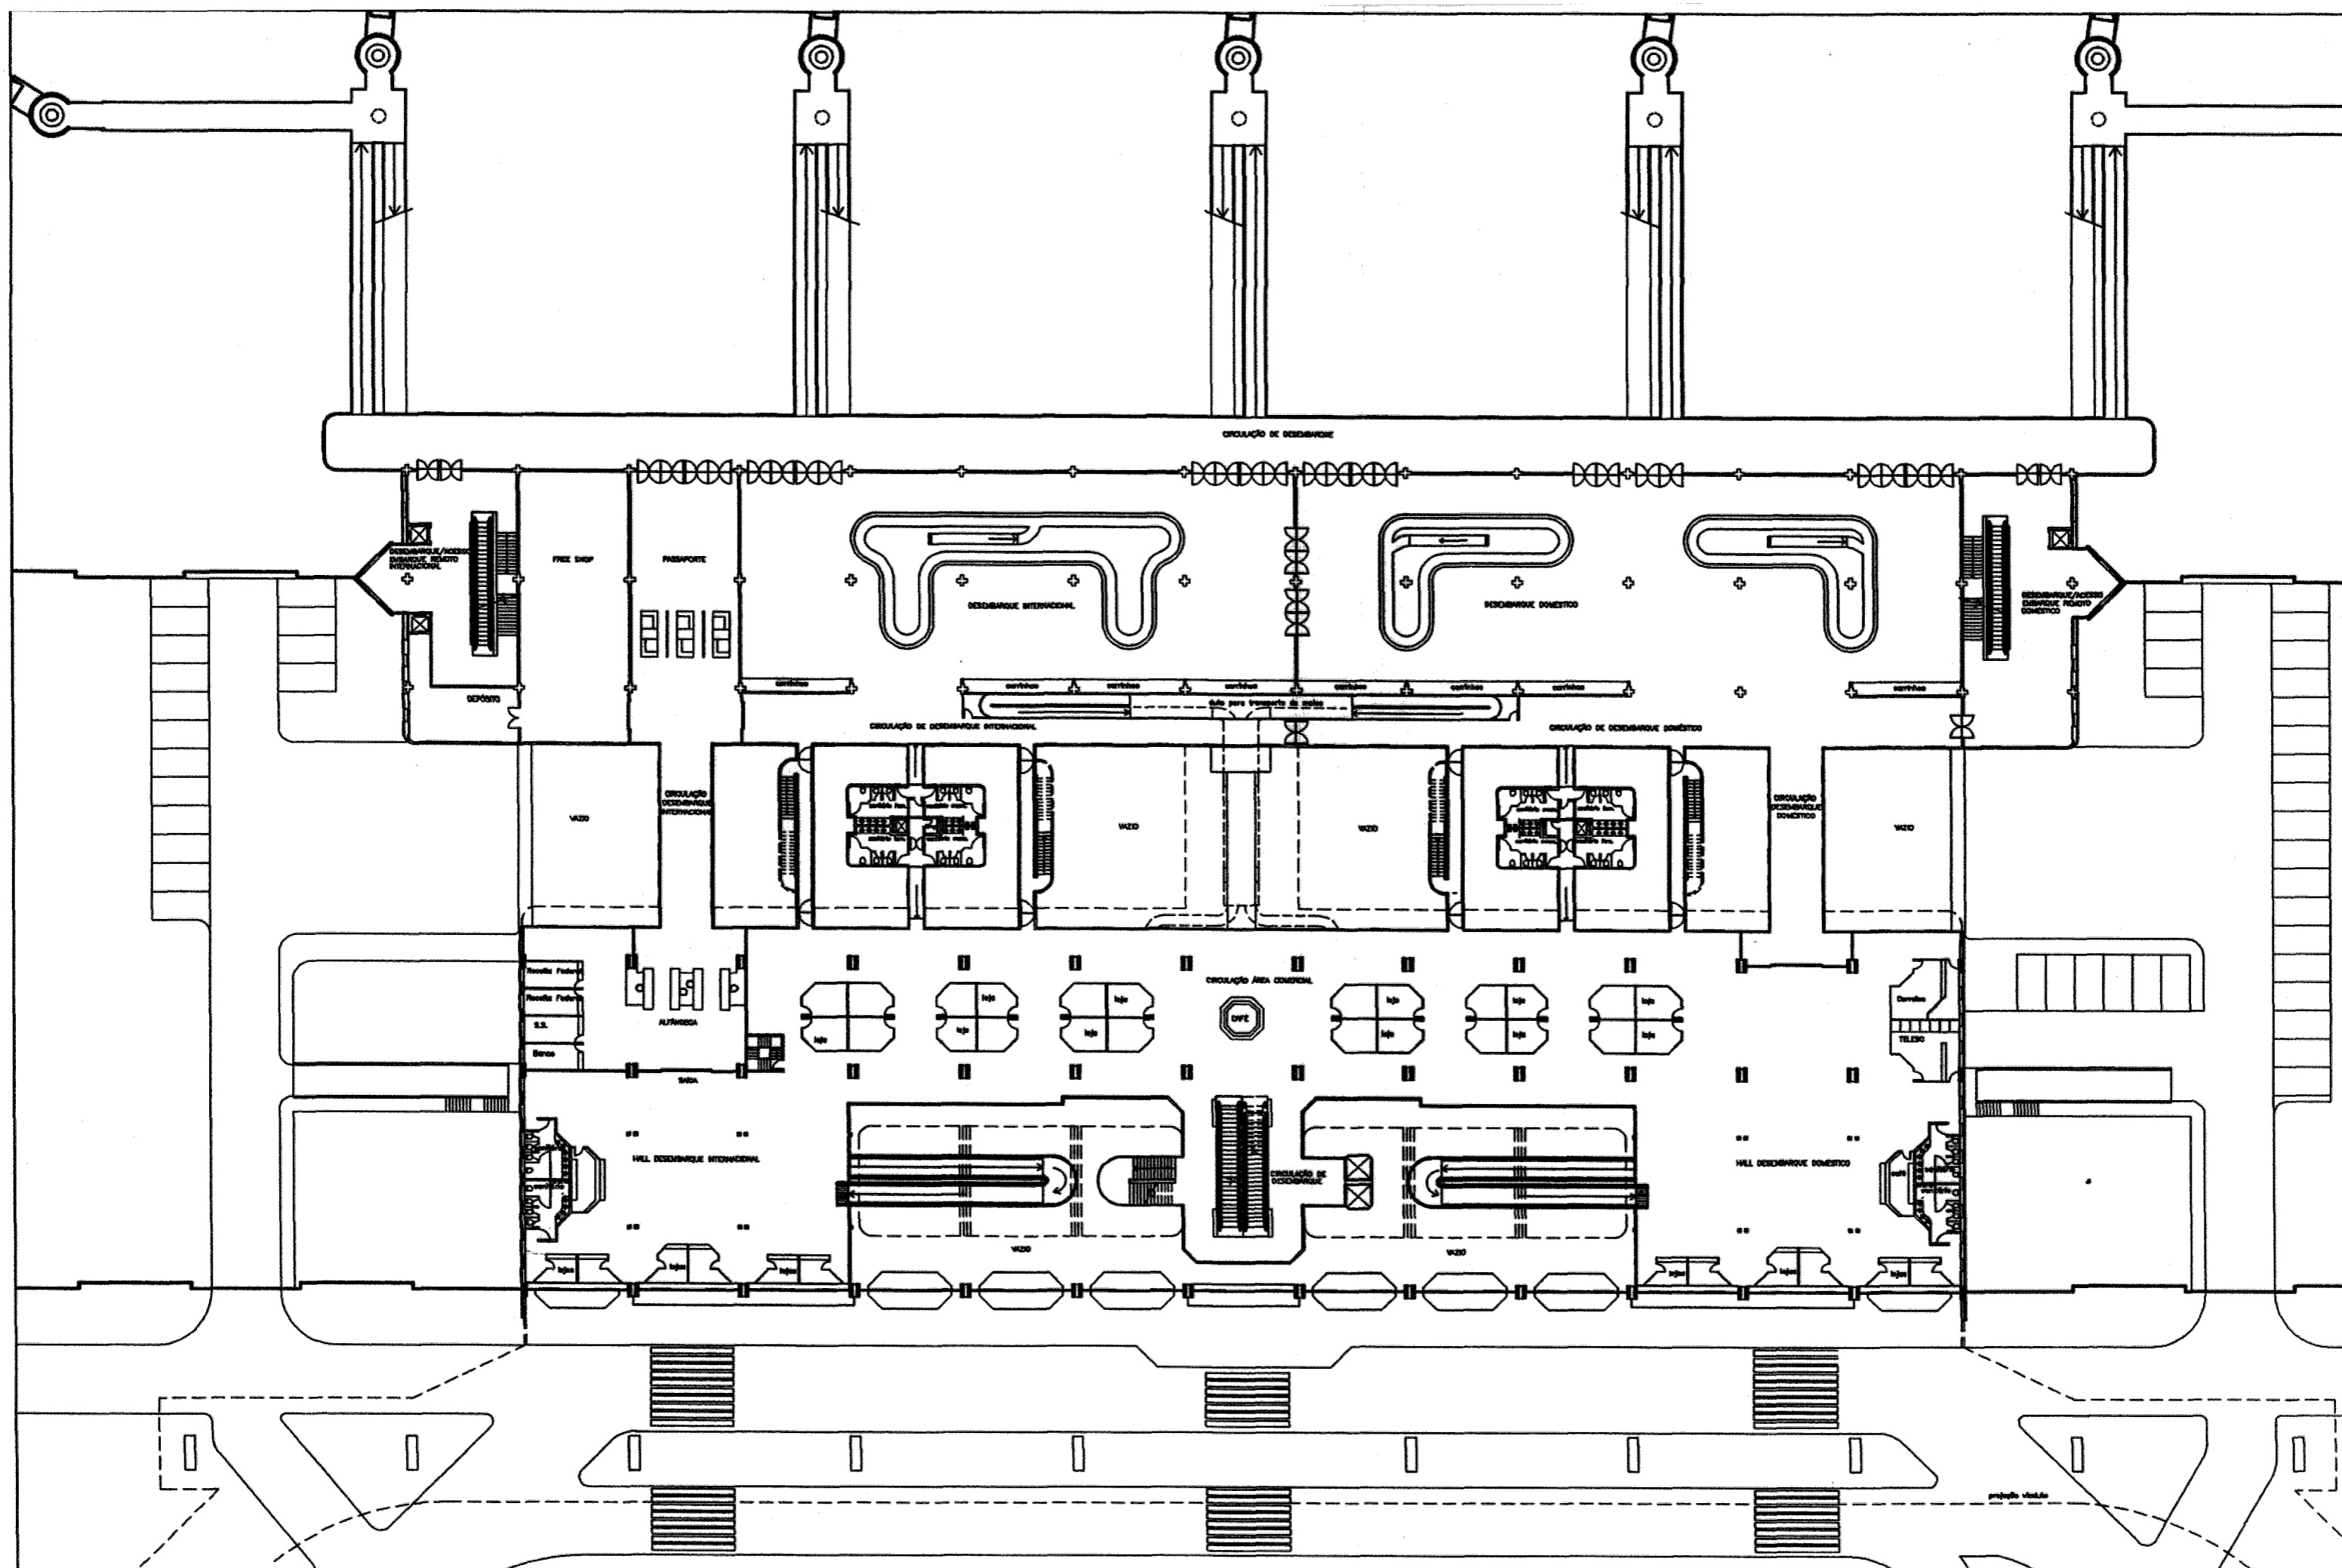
Planta Baixa Nível Desembarque - esc. 1:500.
